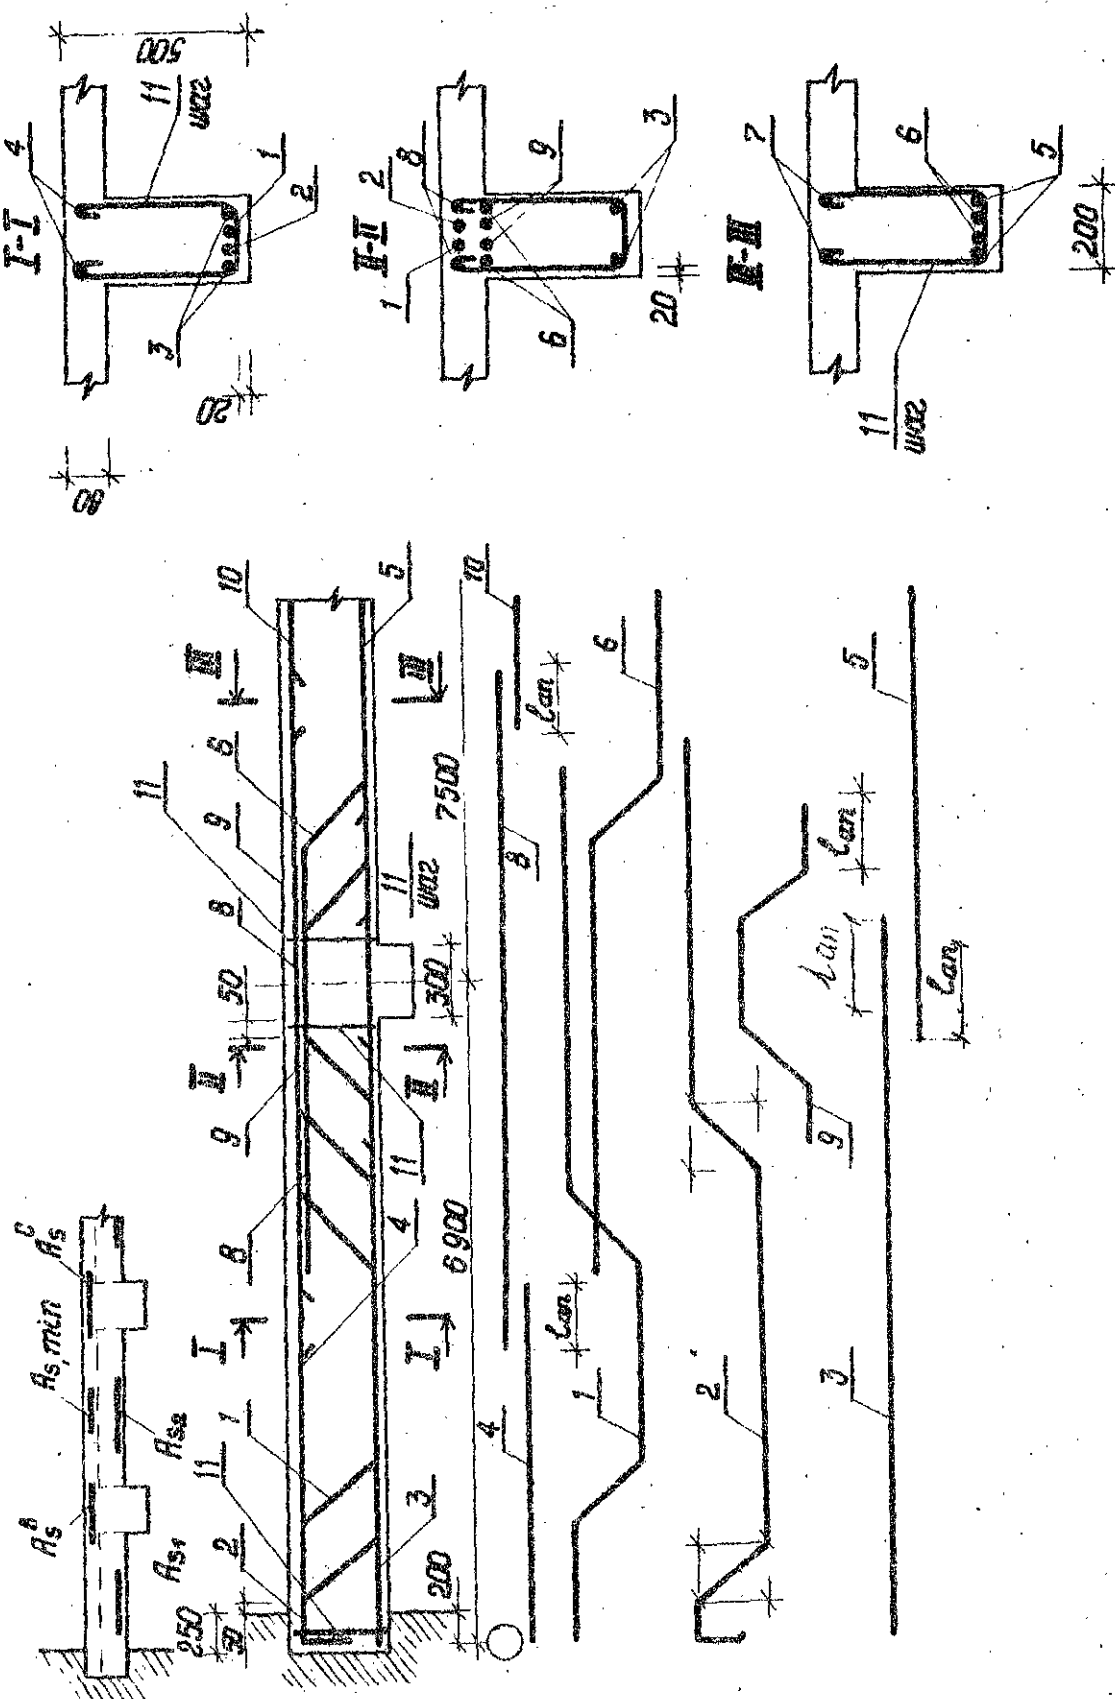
Армирование второстепенной балки вязаными каркасами (отдельные гладкие стержни из стали класса А-1)
